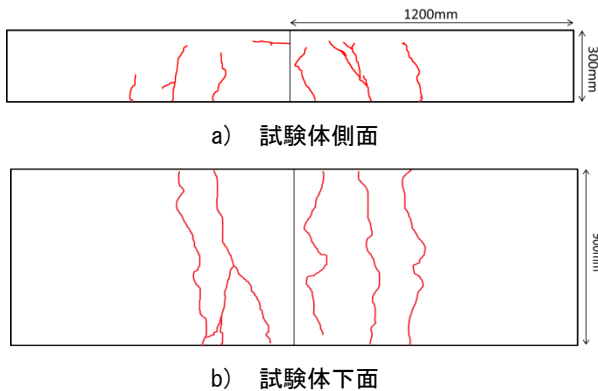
曲げ載荷試験後のひび割れ図 (CASE1)
